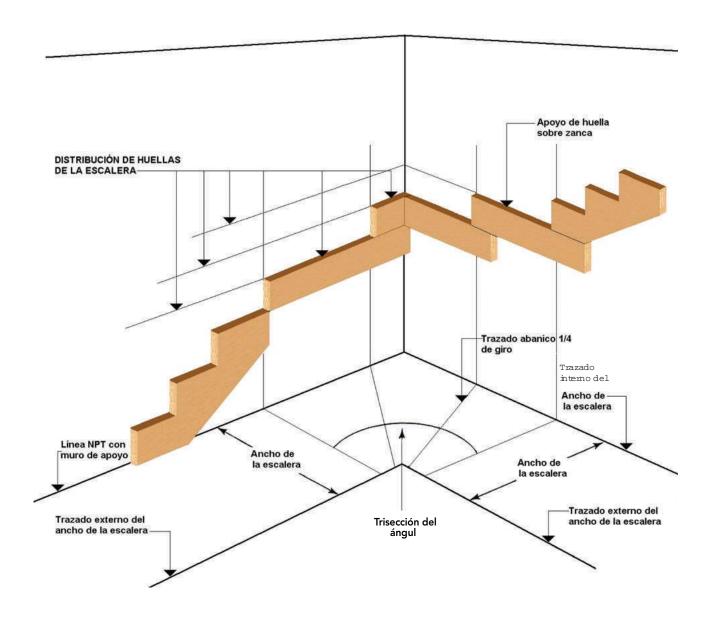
30: Trazado y colocación de zancas y piezas auxiliares de apoyo para huellas y contrahuellas de la escalera.
